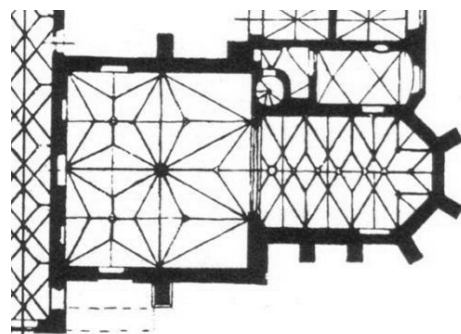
Stiering-Wendel, Kreuzkapelle/Annenkapelle, Grundriss
